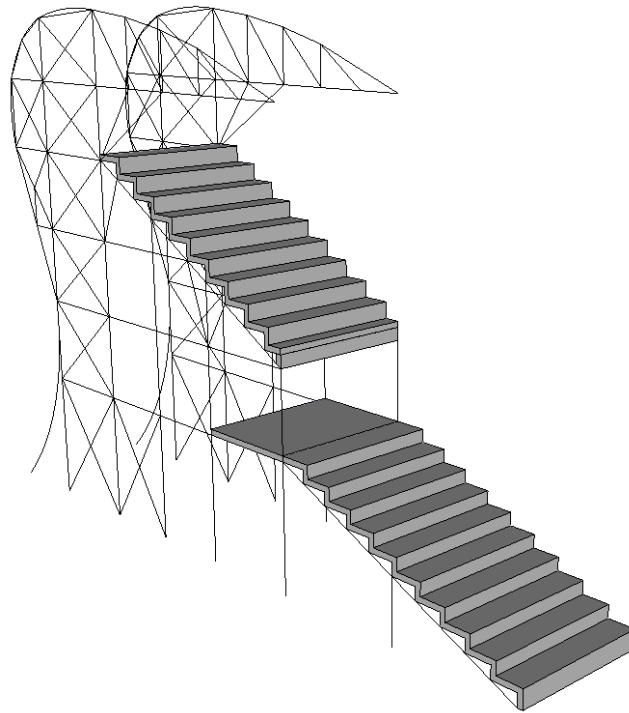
Ubicación de losas de hormigón en la estructura vista 3D
